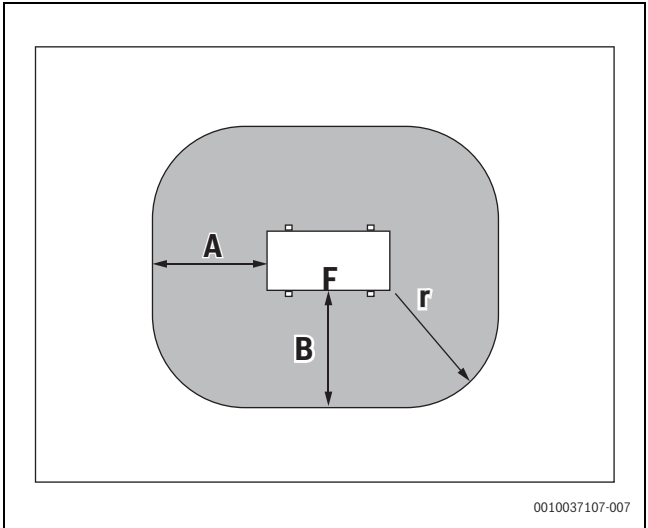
Zona di sicurezza posizionamento a terra su terreno o su tetto, vista dall'alto
